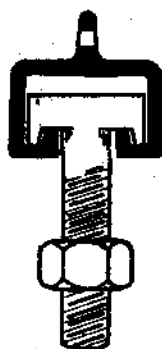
и 222. Подвешивание трансмиссий к железобетонному перекрытию.
